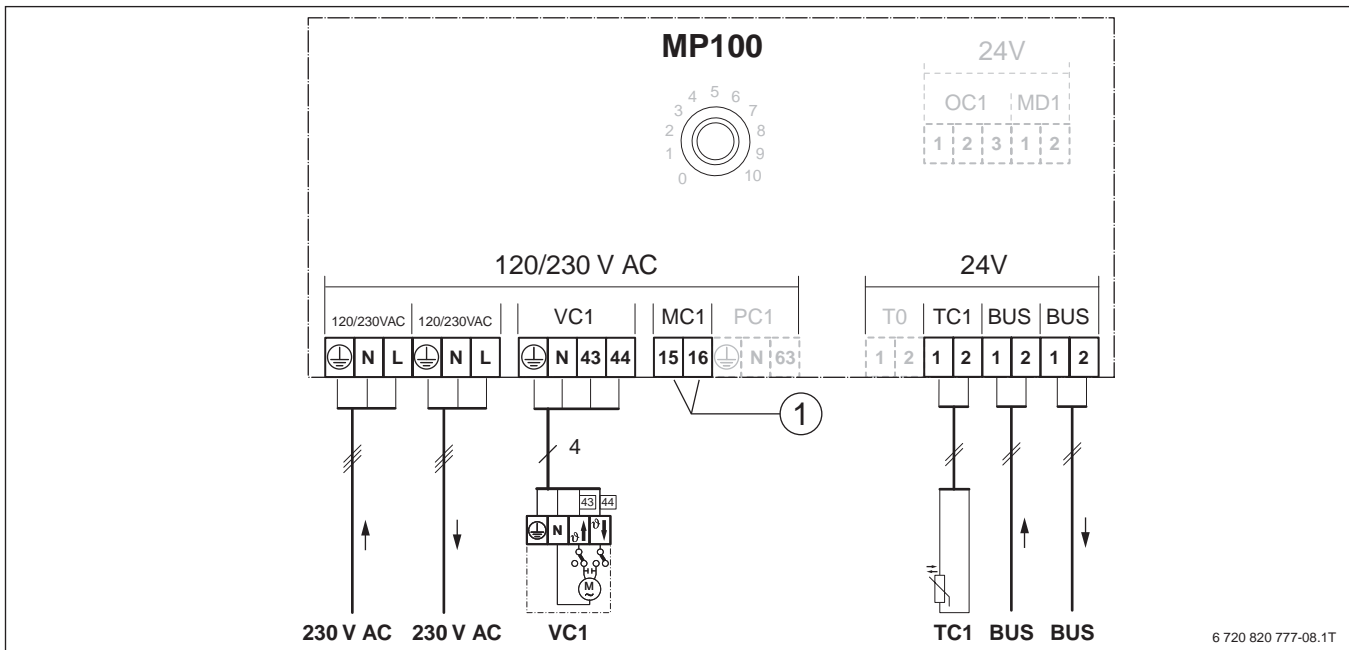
Anschlussklemmen des Schwimmbadmoduls MP100
